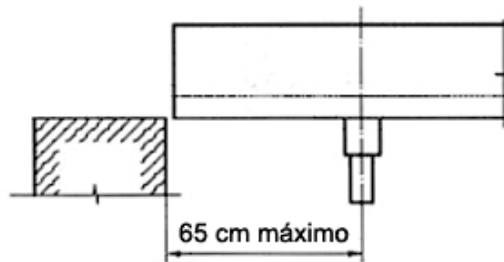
VIGUETA SIN ARMADO SALIENTE
